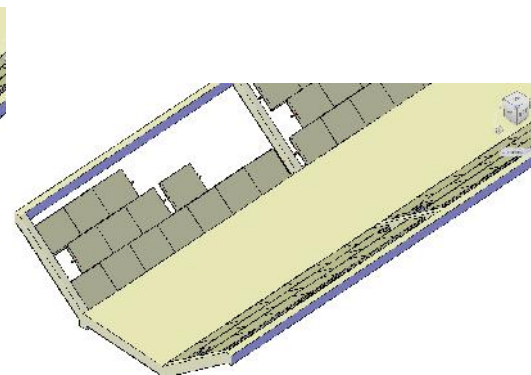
Detail Skema *Lining Precast* 4 sisi
